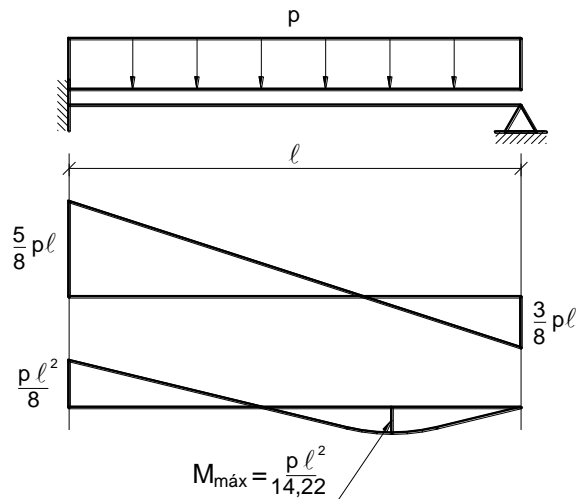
Laje armada em uma direção sobre apoio simples e engaste perfeito com carregamento uniforme.
